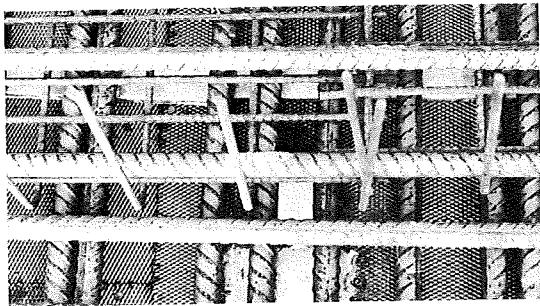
Skelett der Labordecke mit dem Beton-eisen und dem Streckmetall-Abschirmblech vor dem Eingiessen des Betons
